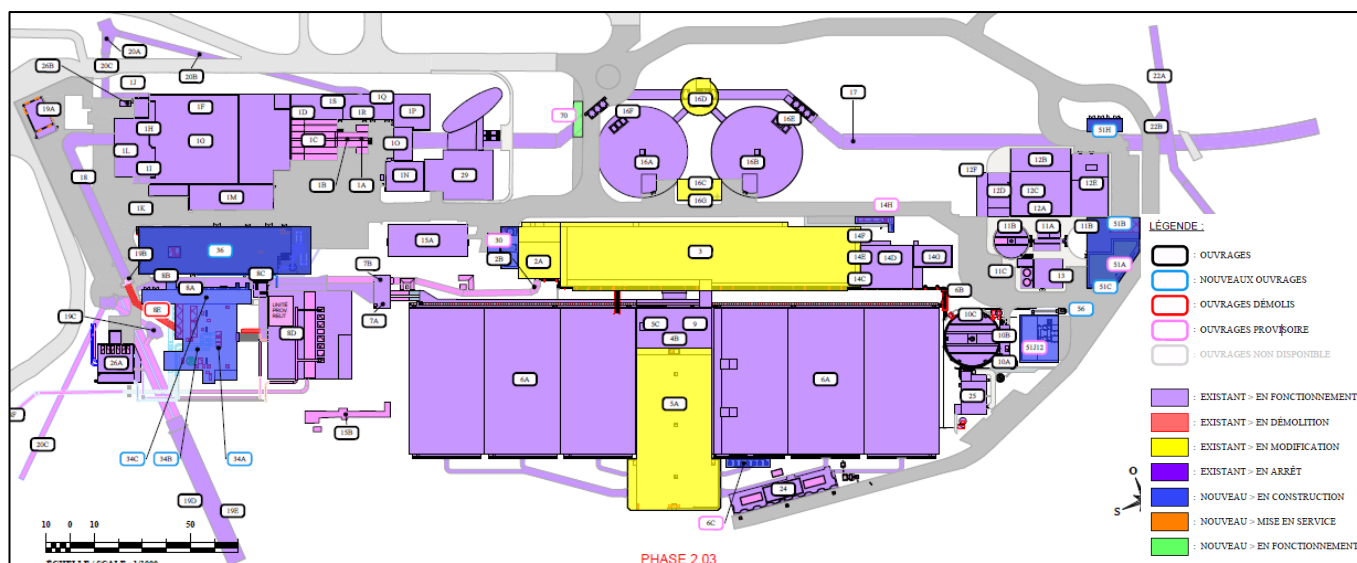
Construction de la nouvelle station de refoulement en mer et construction du bâtiment REUT
